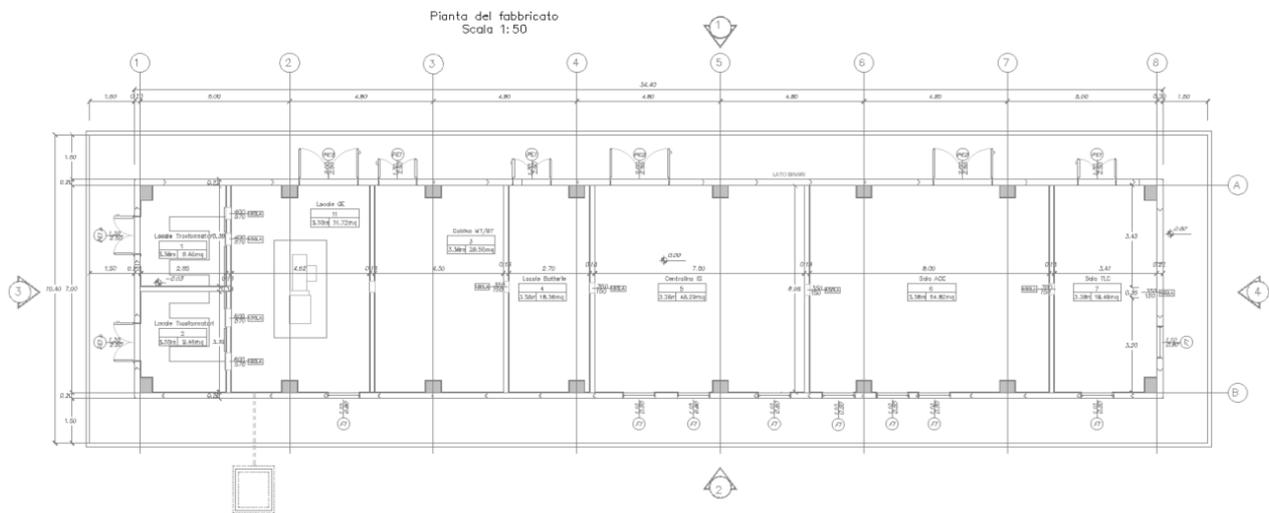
Pianta architettonica – fabbricato tecnologico FA26
